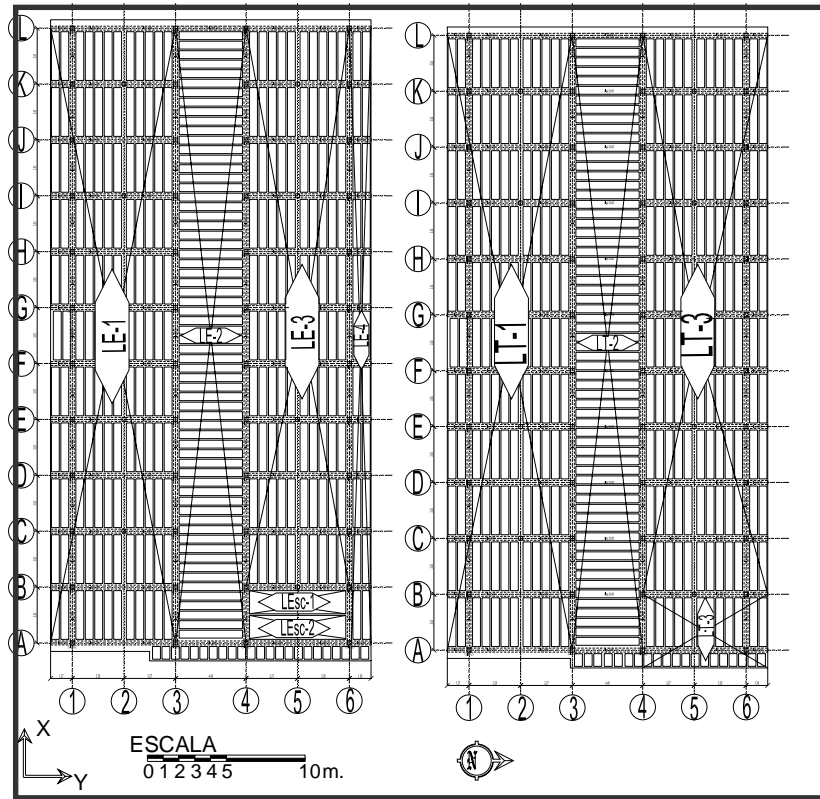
Planos del envigado de las plantas de entepiso y alta de la U.E. Dr. Lisandro Lecuna.
